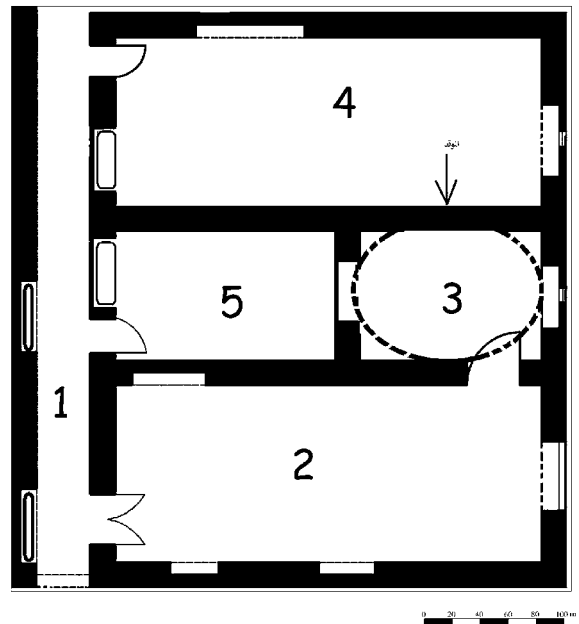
بيت الكعكي: الطابق الأرضي، مسقط أفقي للحمام بالجناح الجنوبي.
